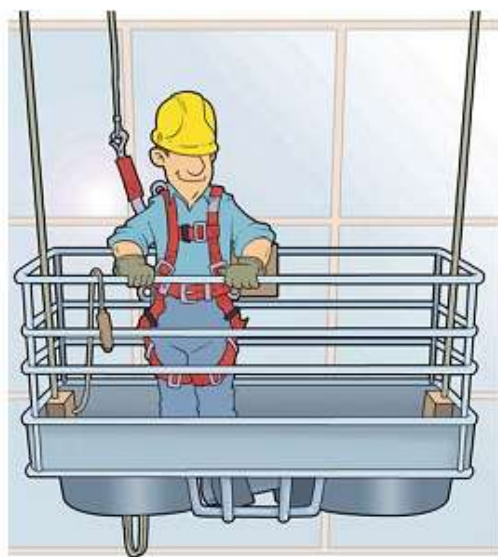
Andamio Colgante. Cámara Chilena de la construcción.
